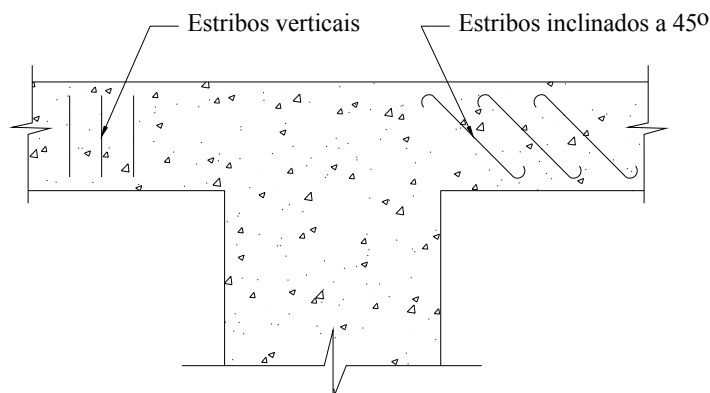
10 Detalhe de estribos verticais e a 45⁰
